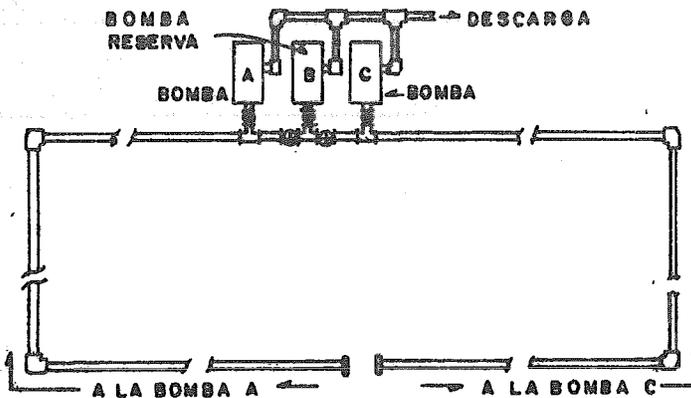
SISTEMA DE BOMBEO DE POZO PUNTA (WELL POINT) (REF.18)
